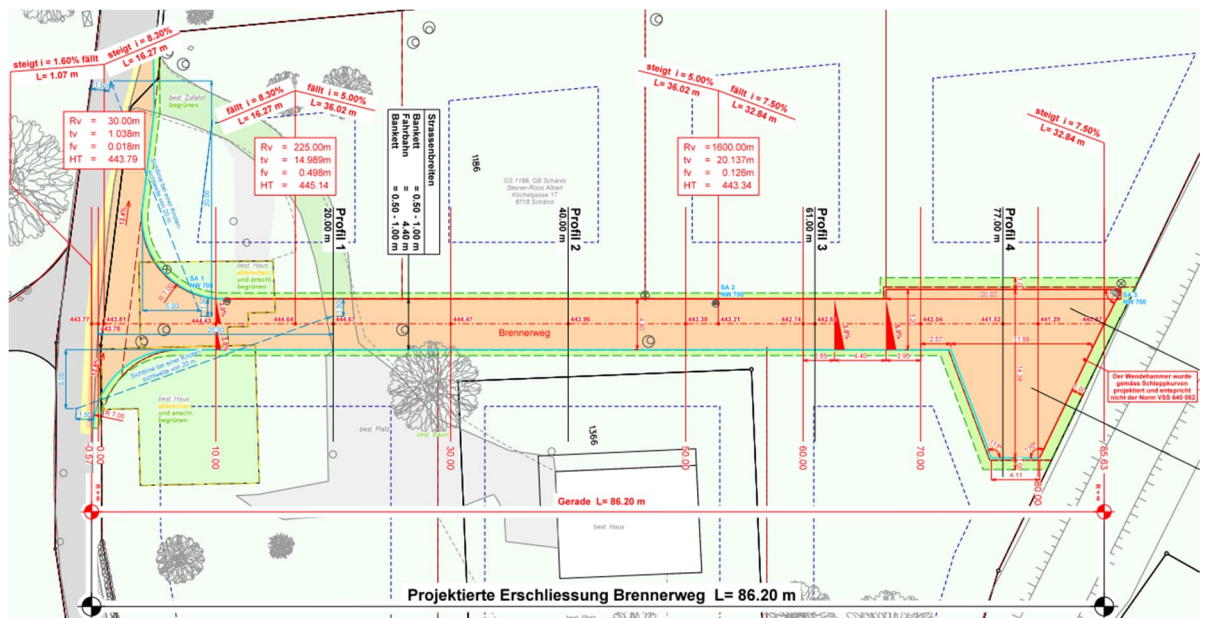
Ausschnitt Situation Projektierte Erschliessungsstrasse, Plan Nr. 1331-001
